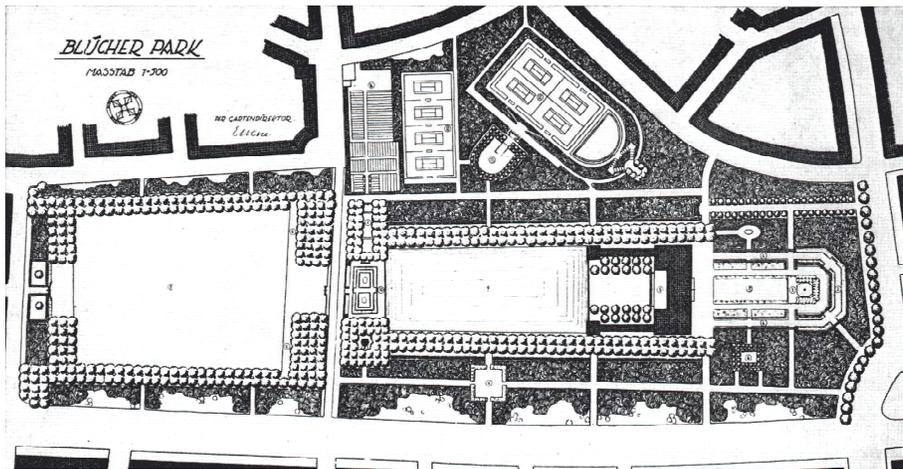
Grundriss des Kölner Blücherparks
